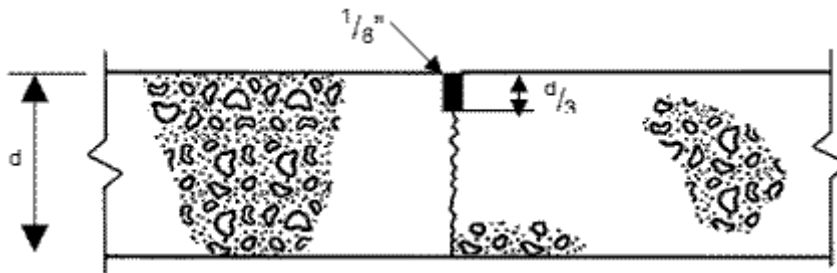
b.13 Junta transversal de contracción sin pasajuntas relación de largo a ancho ≤ 1.25
